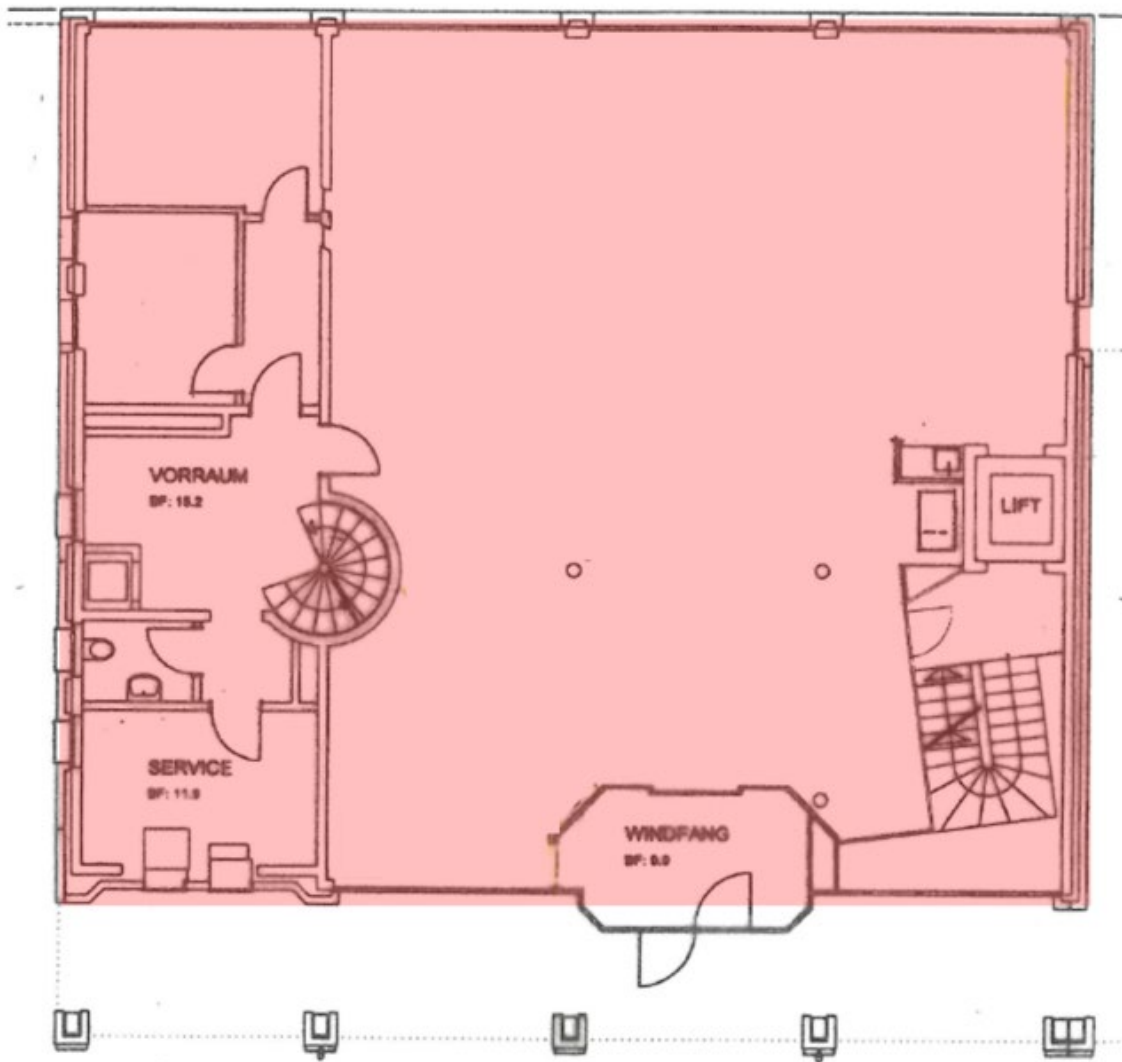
Grundriss Erdgeschoss Rickenbach (ohne Massstab)
